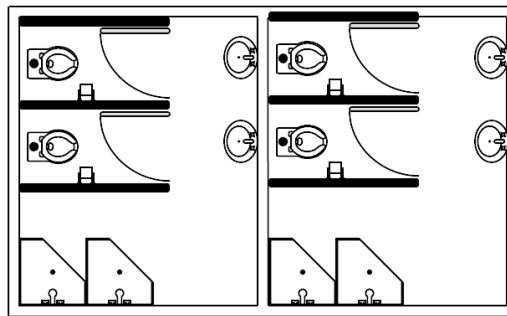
Baños para personal de planta. Fuente: Elaboración Propia.
